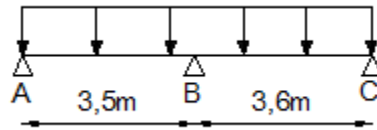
Schéma statique de la poutre reposant sur trois appuis.
